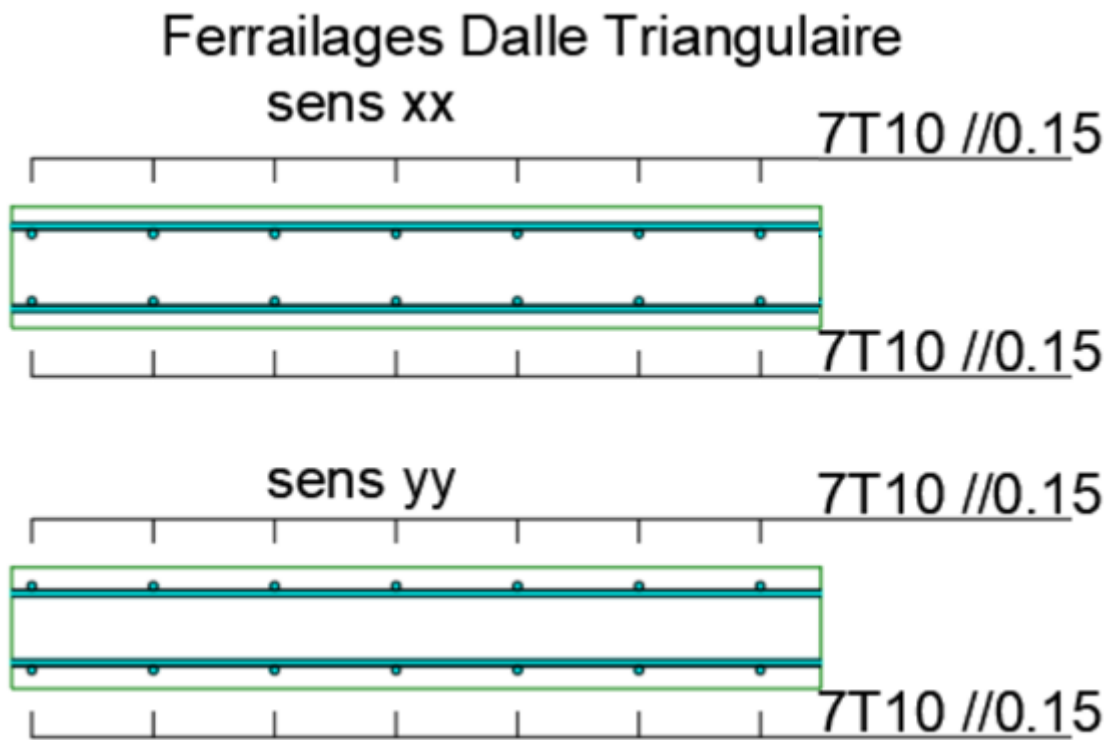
Plan de ferrailage de la dalle triangulaire.
